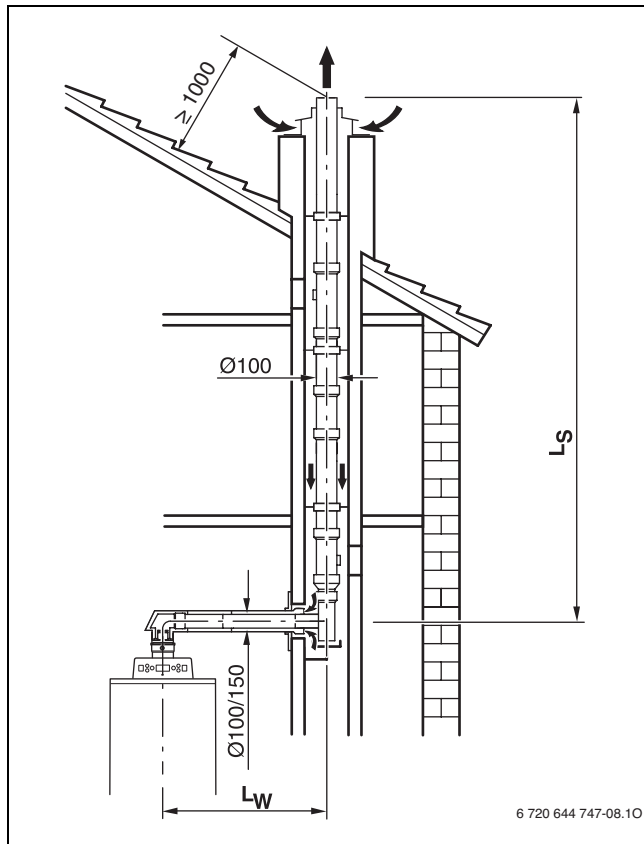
Abgasführung im Schacht starr ($C_{93(x)}$)
